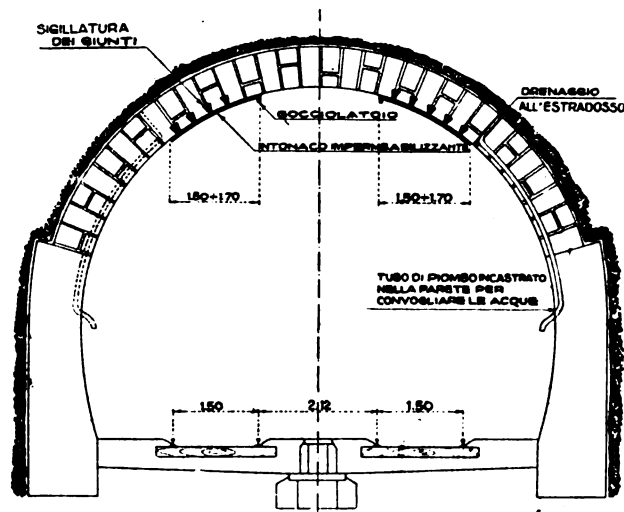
Ferrovie Domodossola-Iselle: Sezione trasversale delle gallerie, con l'indicazione delle zone impermeabilizzate e della disposizione dei drenaggi.
